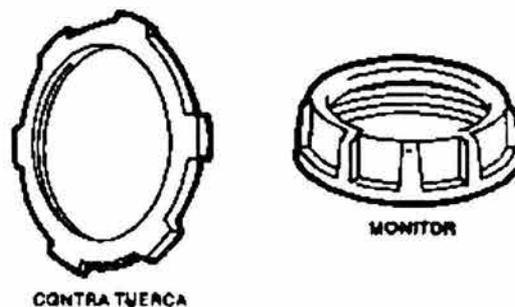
Accesorios de tubería pared gruesa galvanizada.
